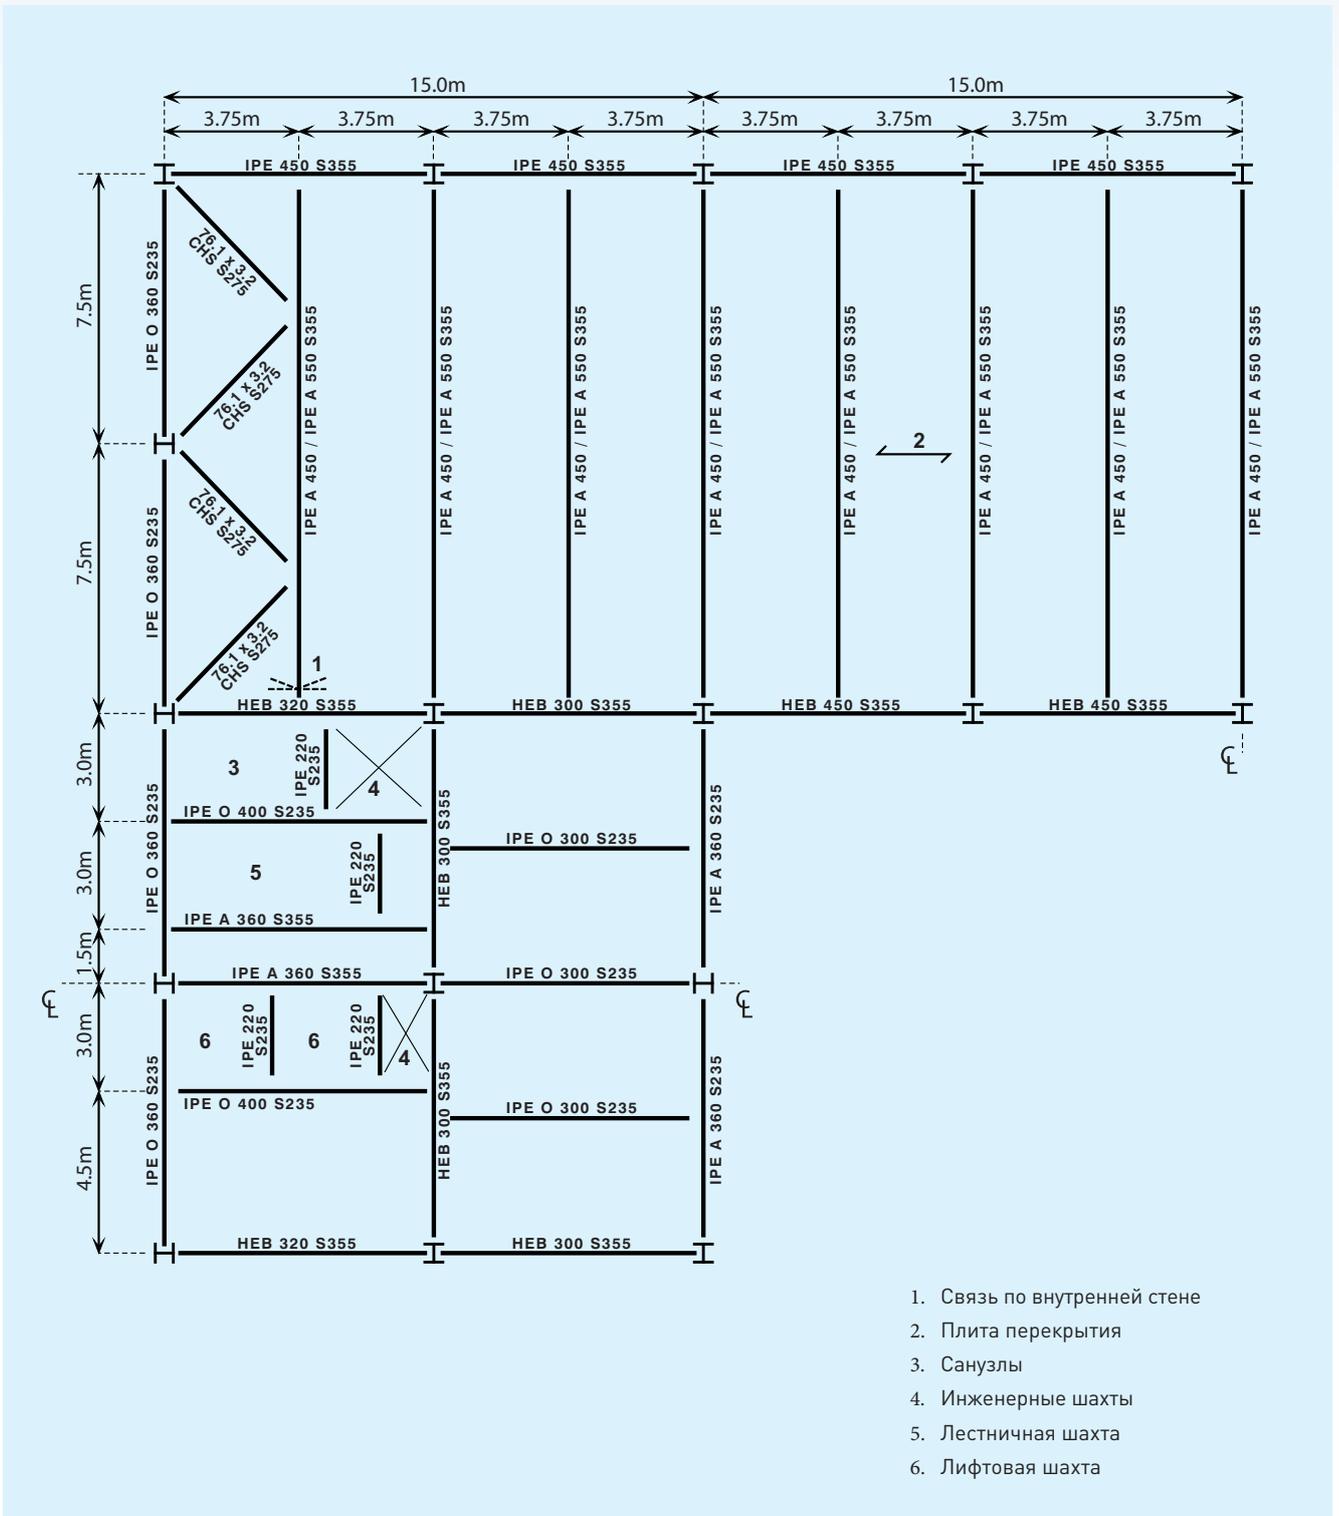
Большепролетные перфорированные второстепенные балки. Пример схемы расположения металлоконструкций каркаса в угловой зоне 8-этажного здания с атриумом
